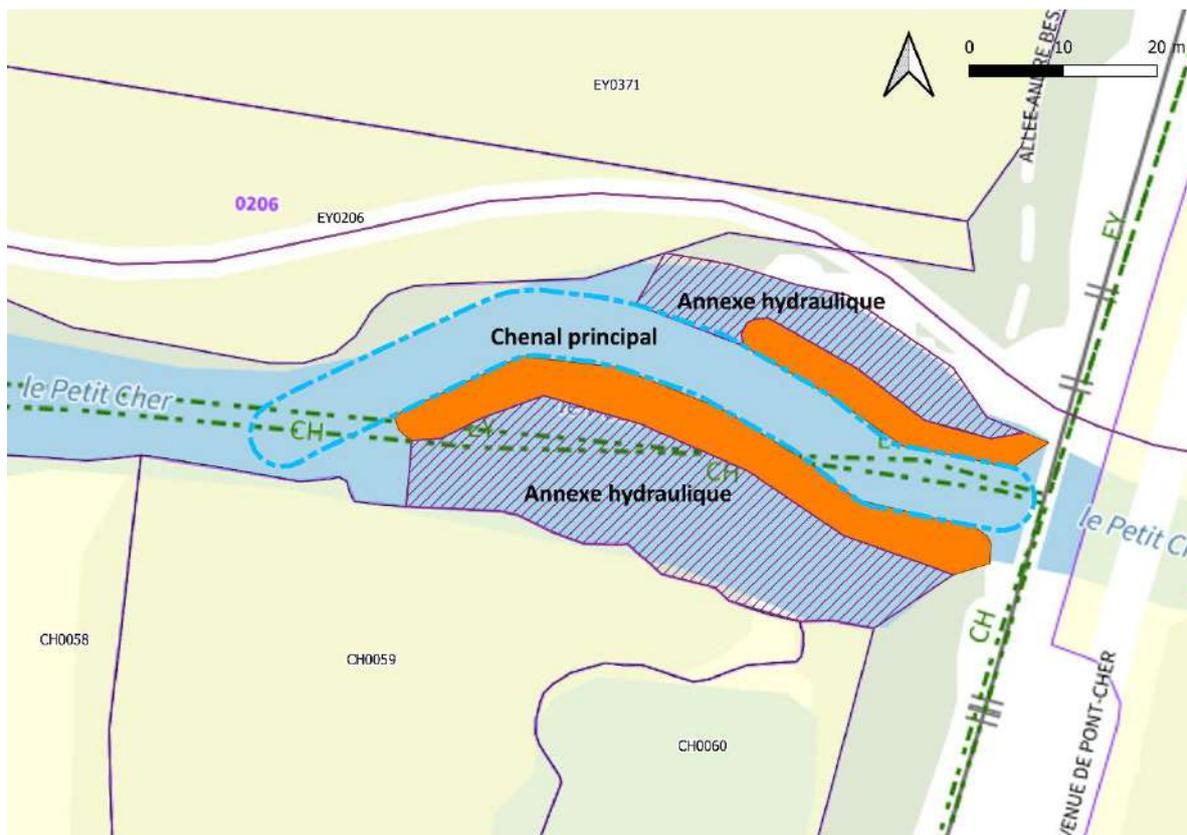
Schéma de principe de l'aménagement (fond : plan IGN)
